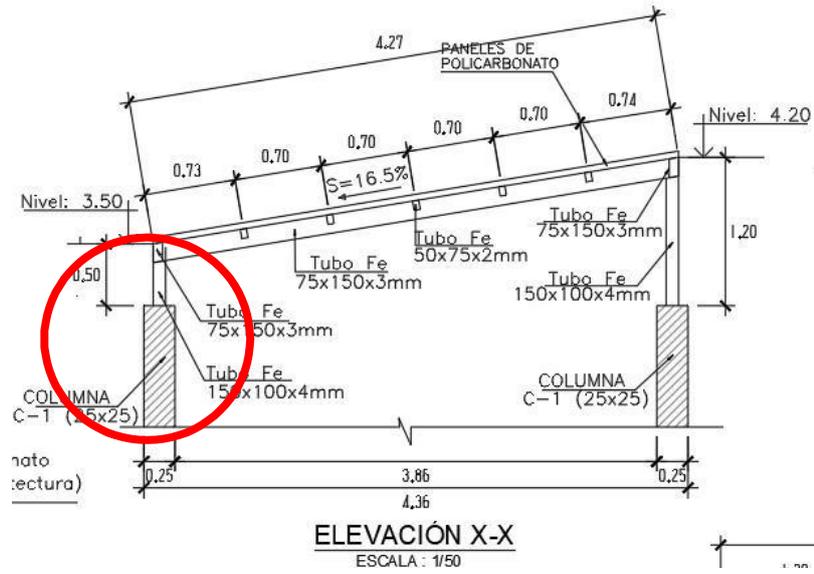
Vista del detalle de elevación x-x de la lámina E-10
